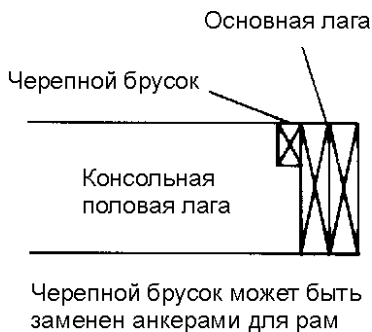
Установка черепного бруска в верхней части лаги служит хорошим креплением (анкером)
